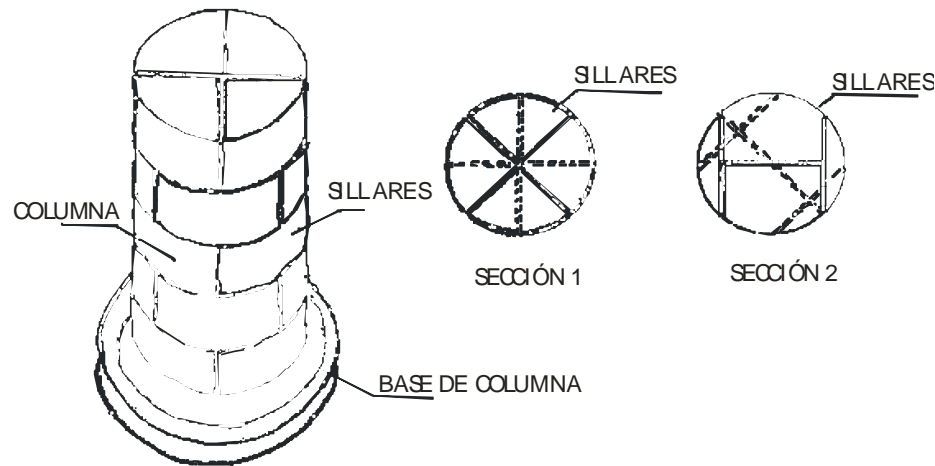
Detalle constructivo de columna de sillares de hoja.
